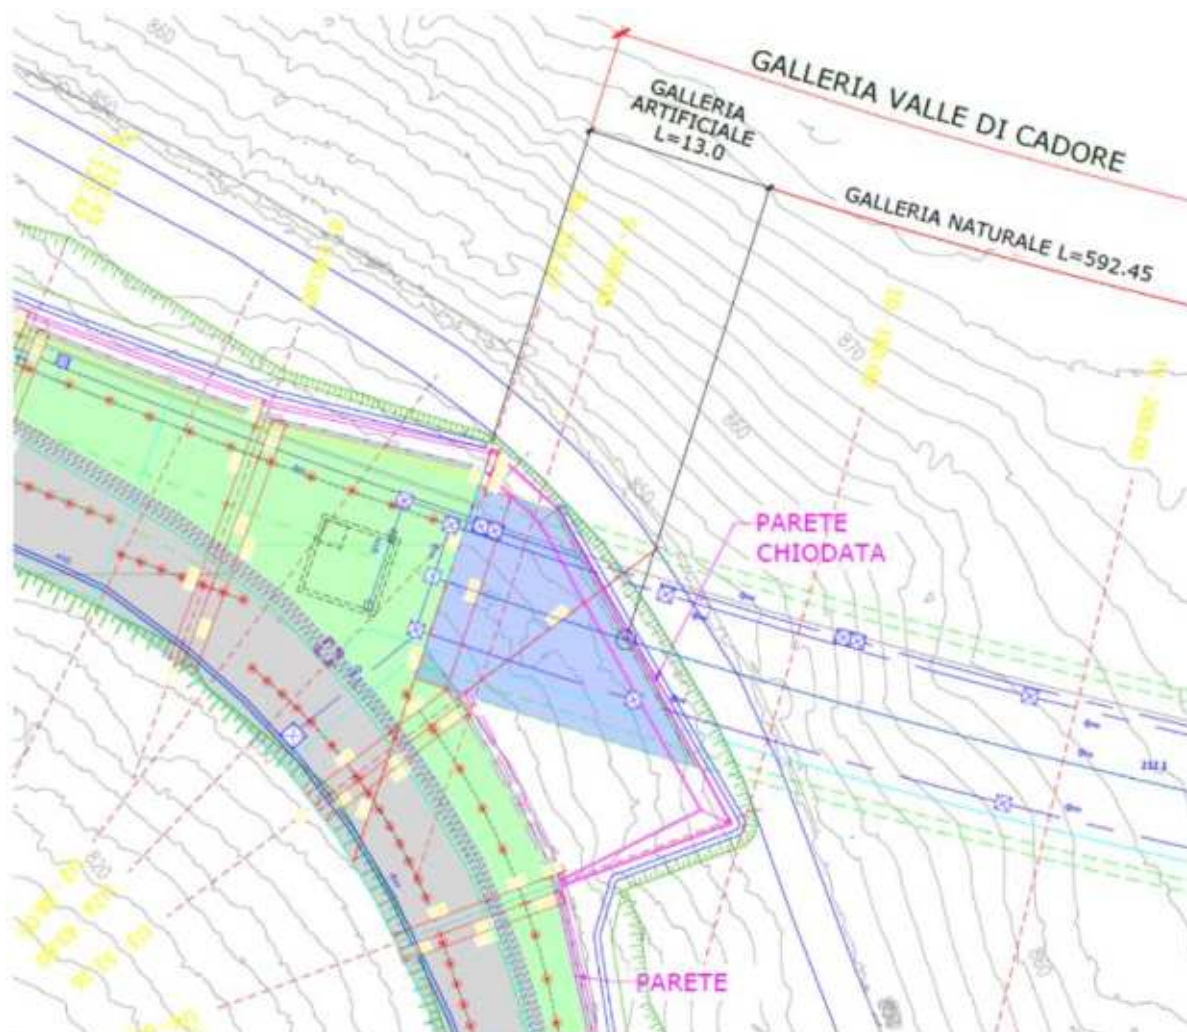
Particolare galleria artificiale planimetria generale PC
